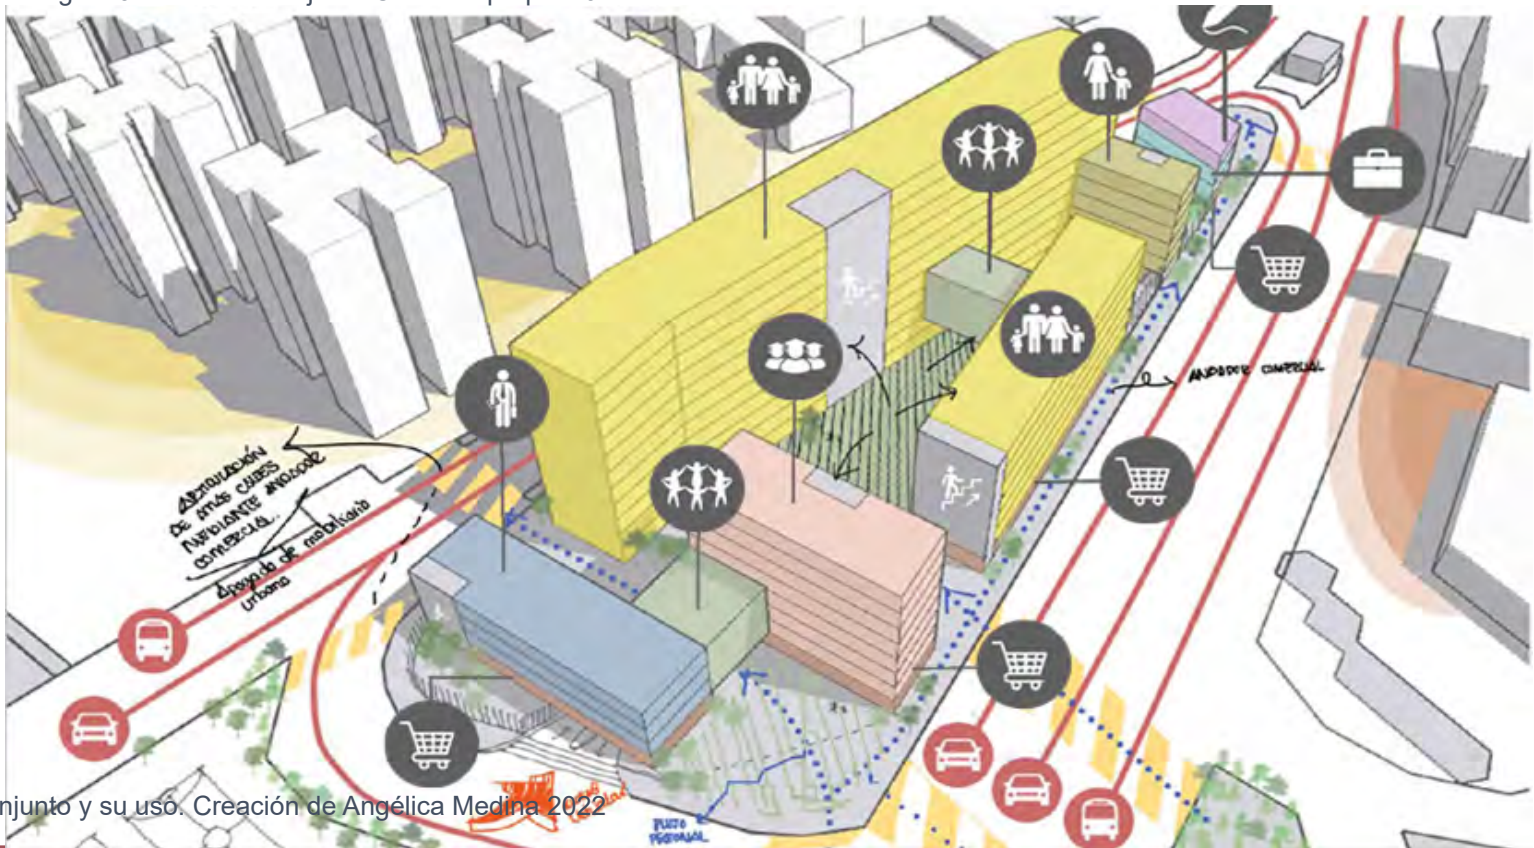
Planta de conjunto y su uso. Creación de Angélica Medina 2022
